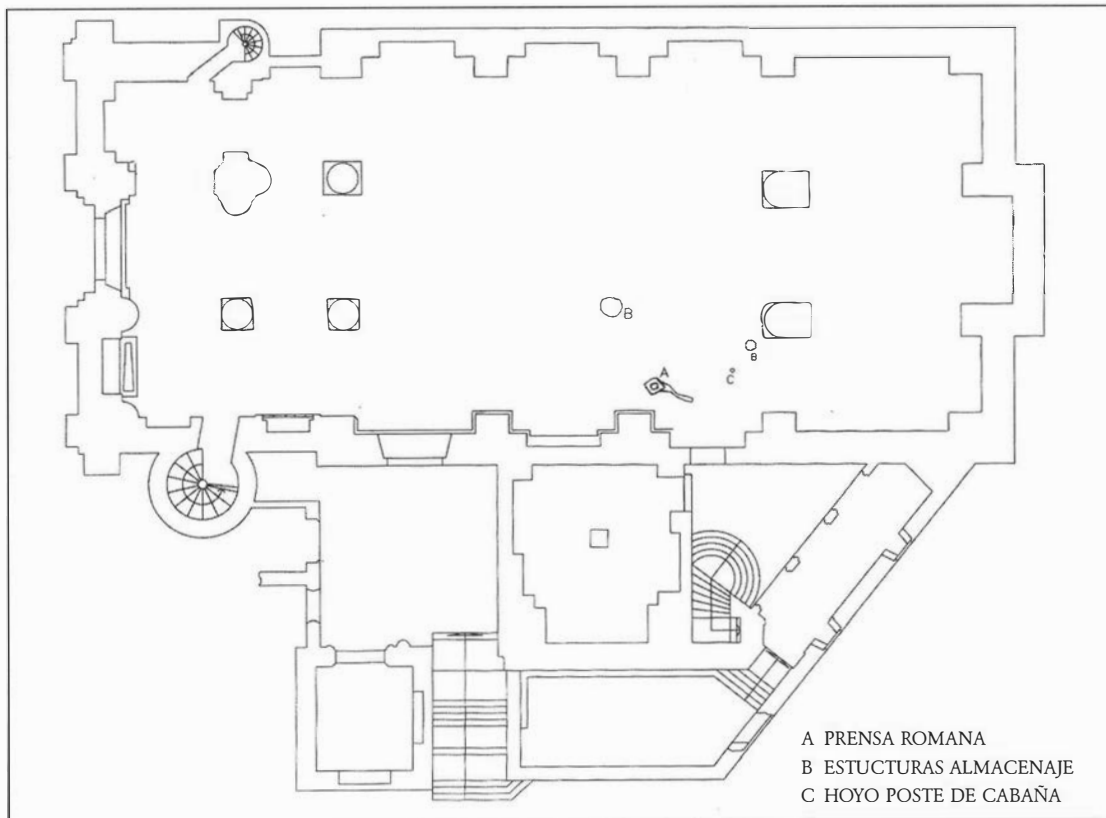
Estructuras de época prerromana. Planta y secciones.
